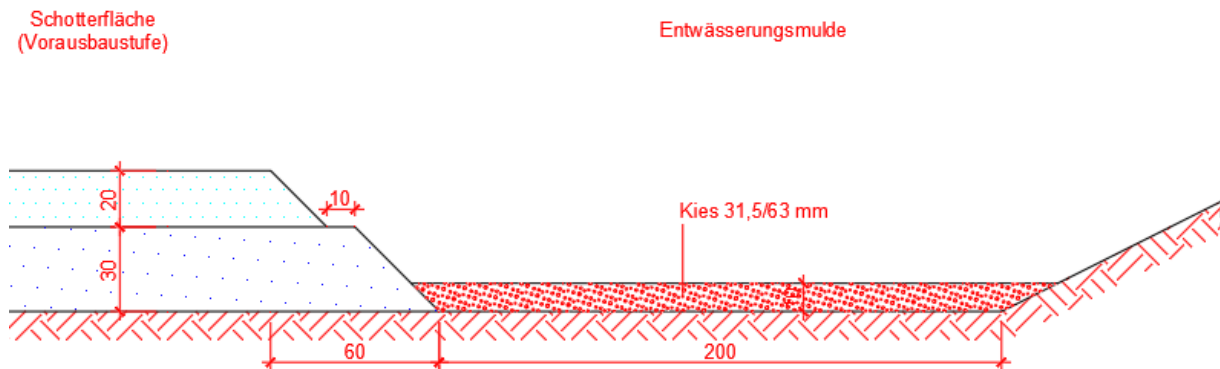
Geplante Entwässerungsmulde / Böschungsfuß (Auszug Plananlage C3.6)
